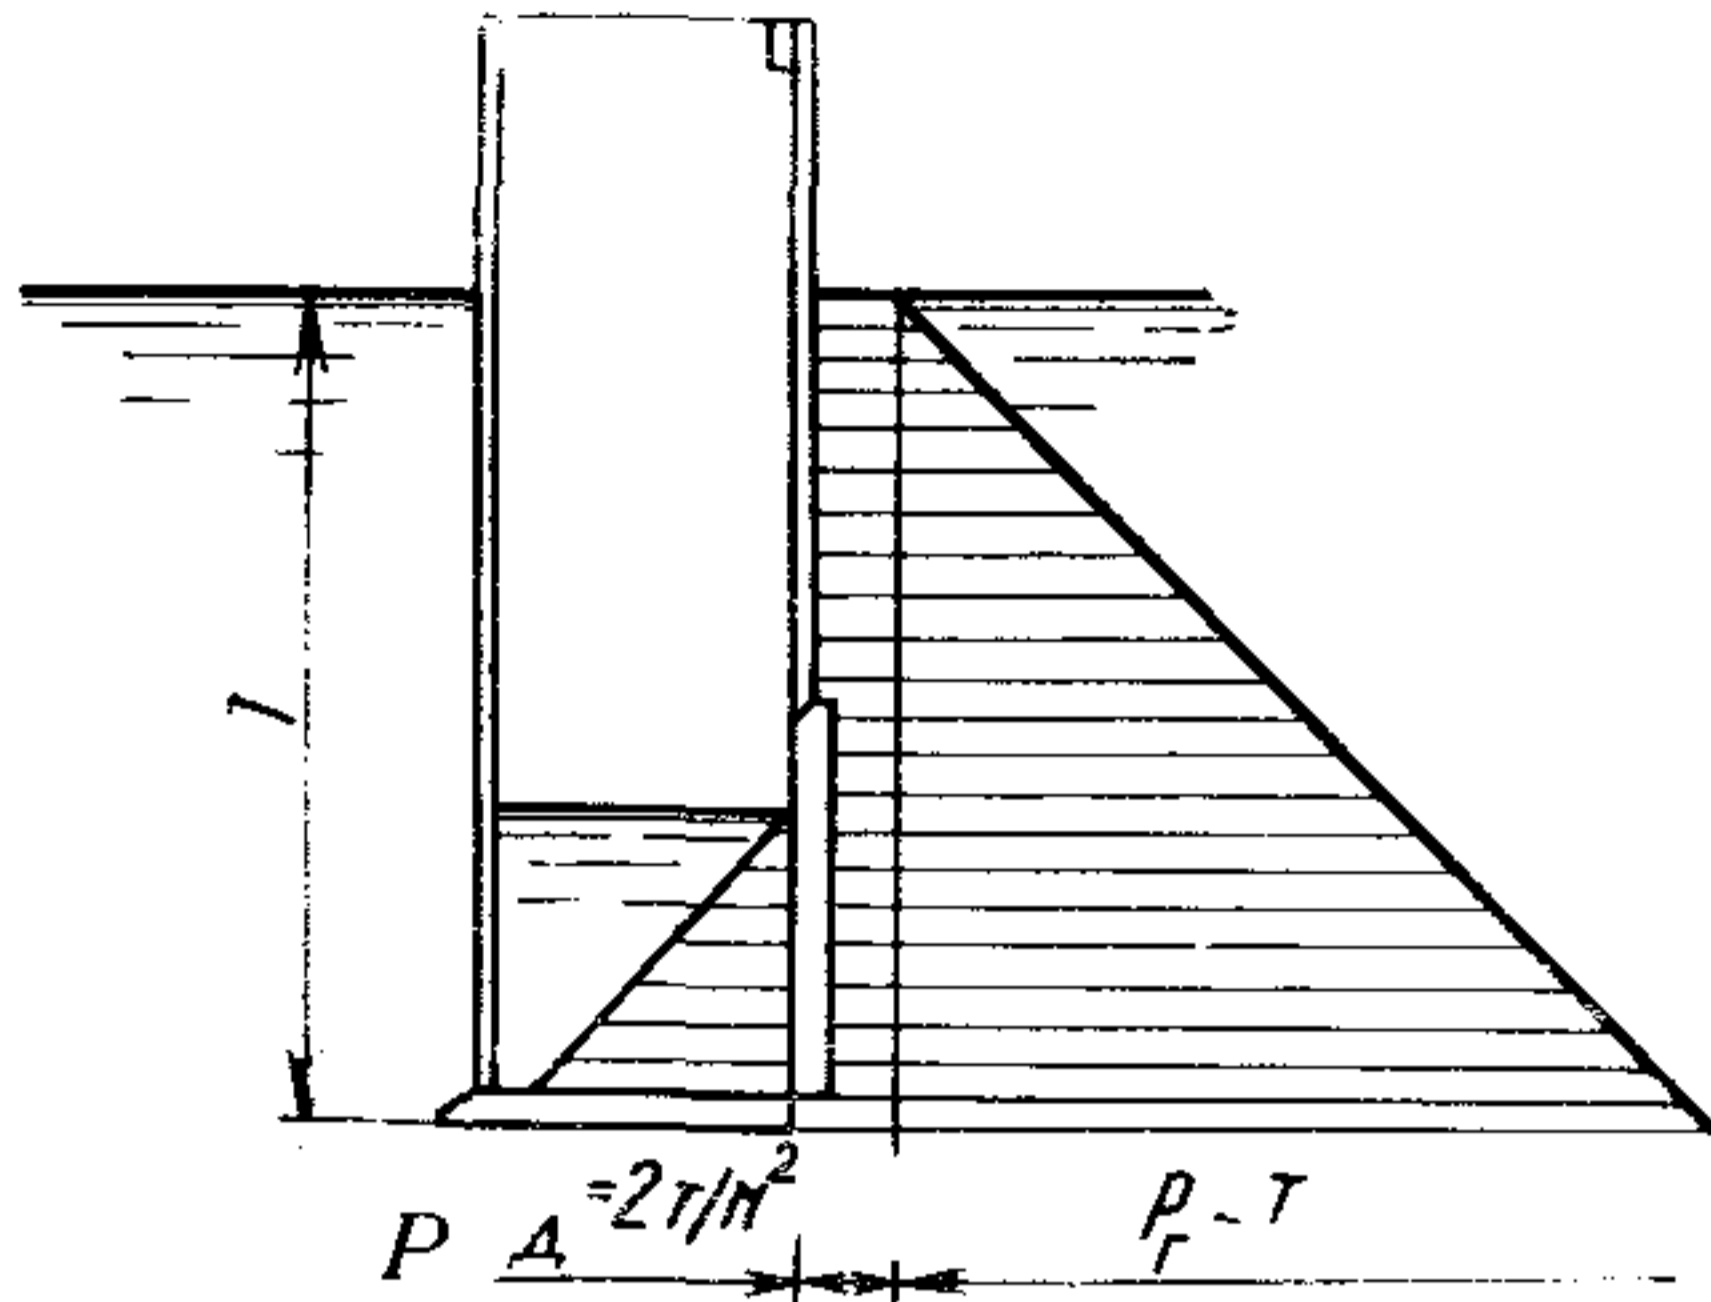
Схема к расчету наружной стенки массива-гиганта
